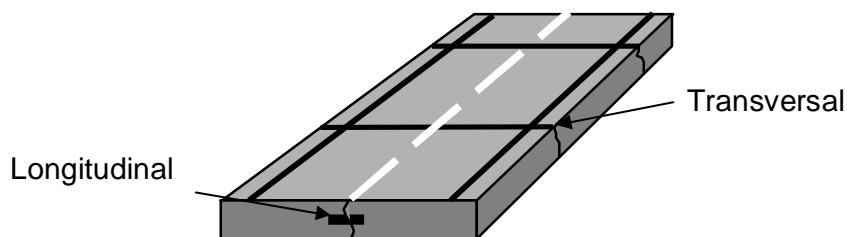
Esquema de juntas longitudinais e transversais.
